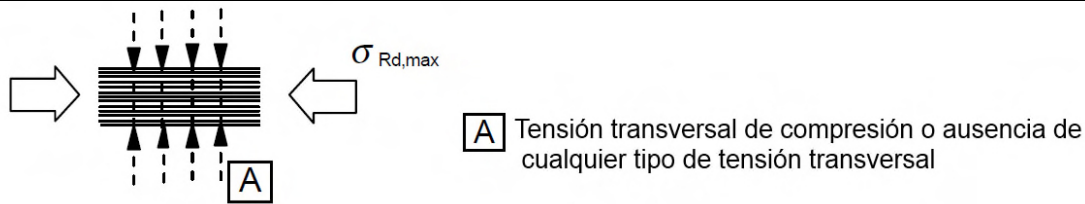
Resistencia de cálculo de las bielas de hormigón sin tracción transversal
